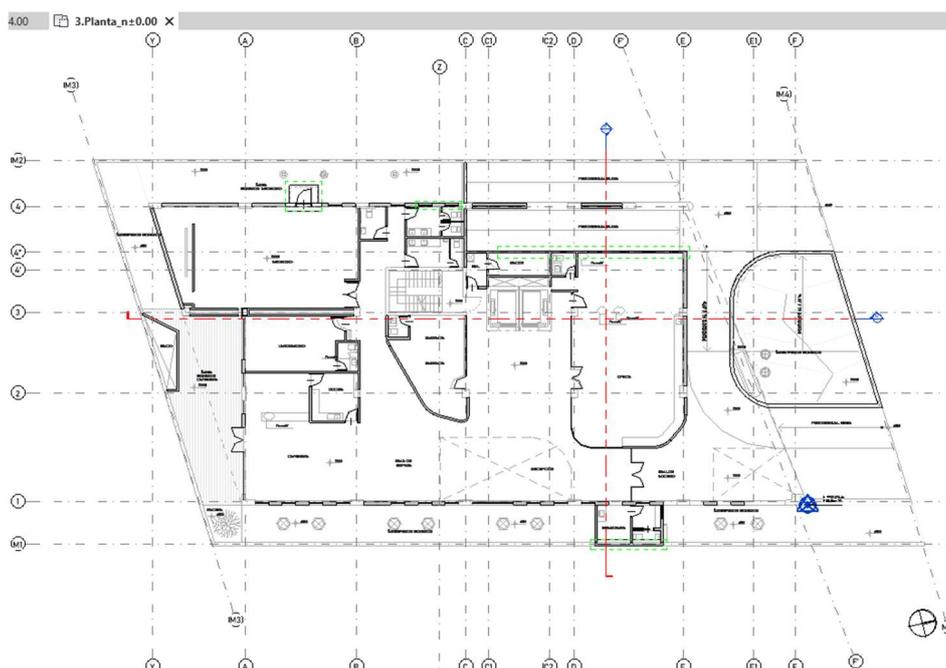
Vinculación Planos DWG al Modelo de Arquitectura
